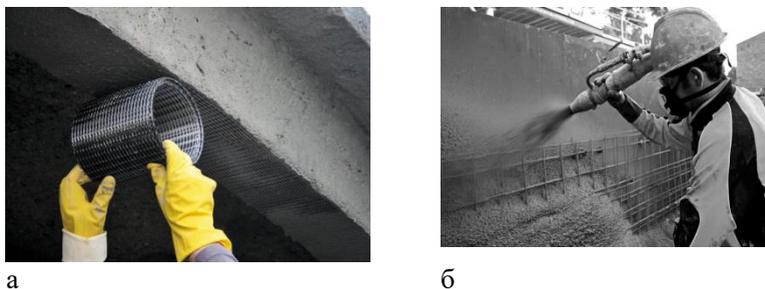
Монтаж текстиль-бетона; а – монтаж сетки из углеродного волокна; б – нанесение бетонной смеси торкретированием
